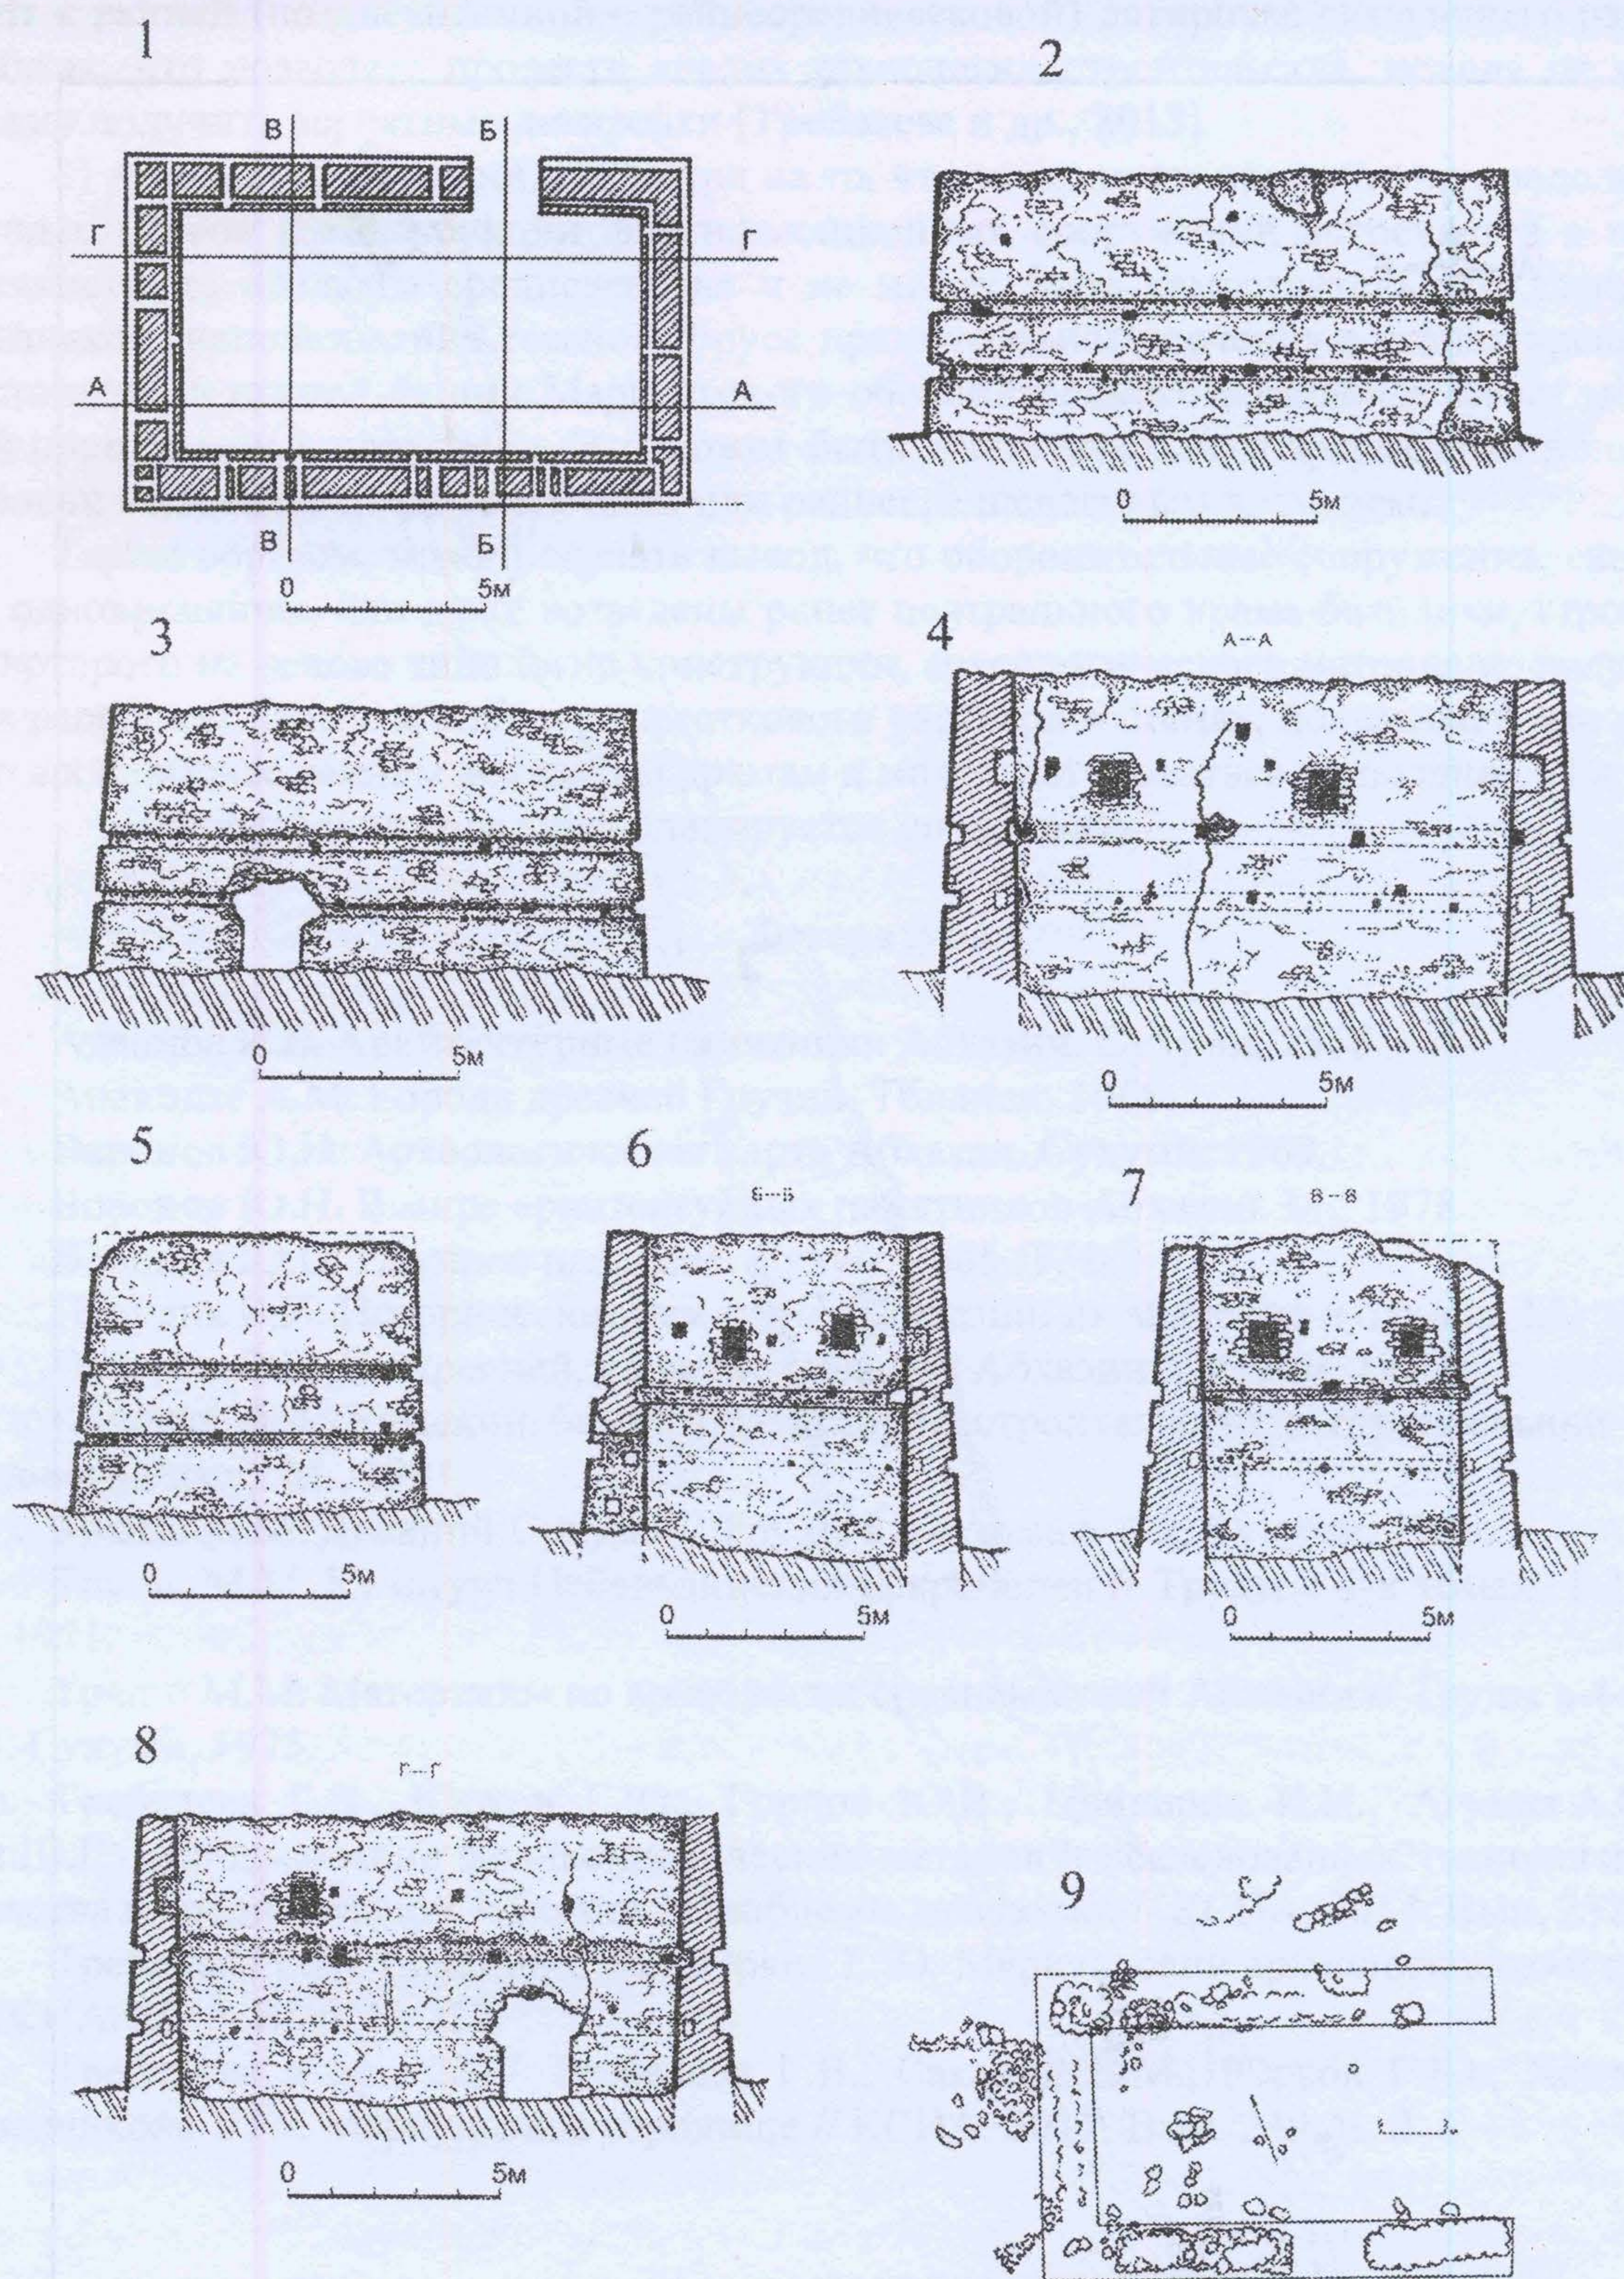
Планы башен. 1 – план южной башни Алахаш-Абаа; 2 – Северная стена снаружи; 3 – Южная стена снаружи; 4 – Северная стена, разрез А-А; 5 – Восточная стена снаружи; 6 – западная стена, разрез Б-Б; 7 – Восточная стена, разрез В-В; 8 – Южная стена, разрез Г-Г; 9 – северная башня, план на основе фотограмметрии.
